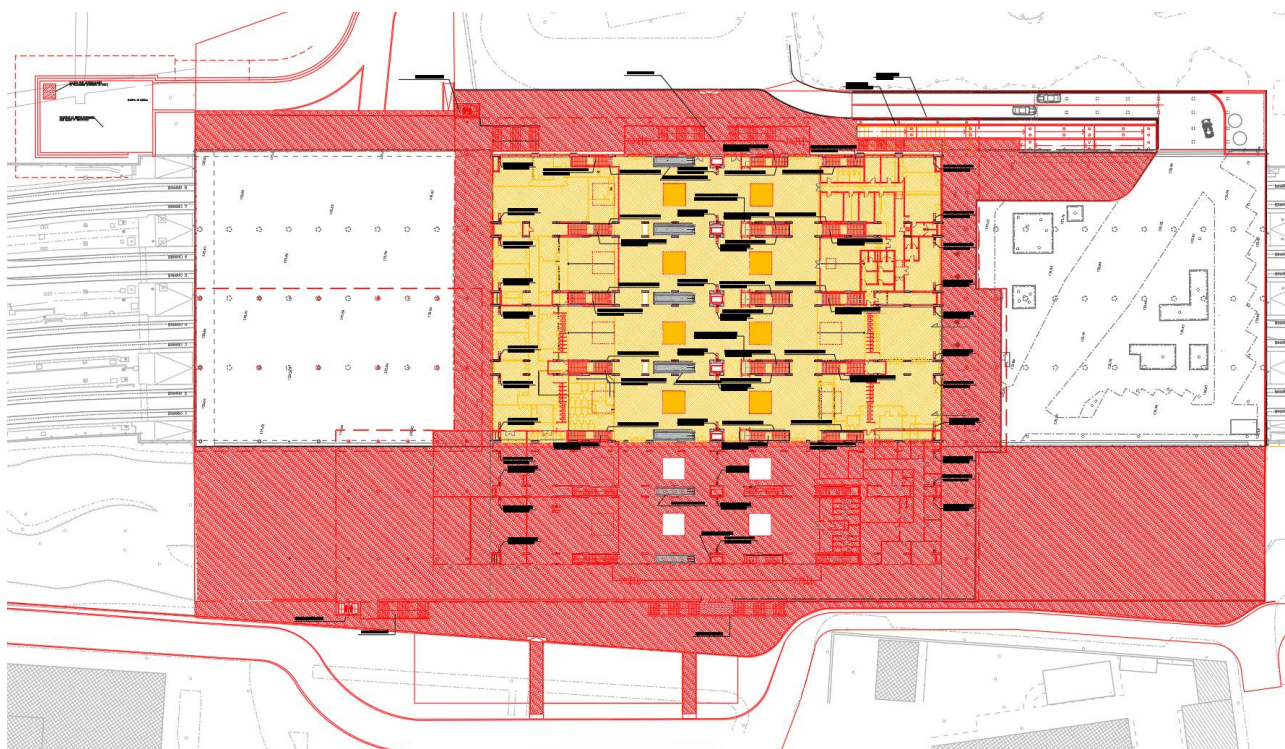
Planimetria demolizioni Piano Ingressi (demolizioni in giallo)
